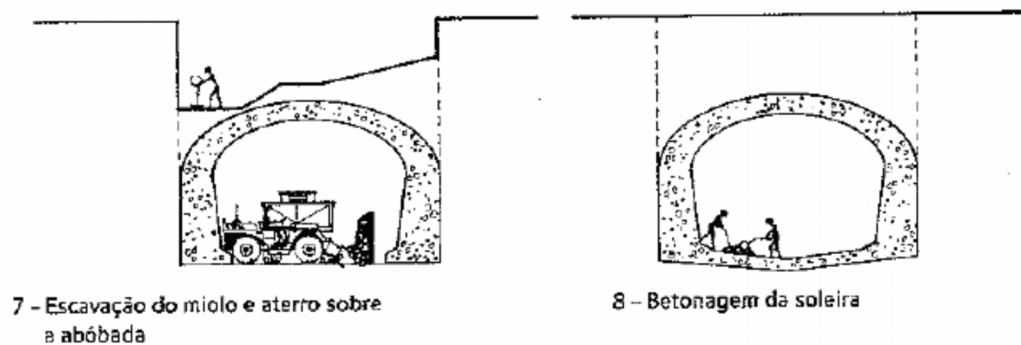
Cut and Cover* - (Vala Estreita), Escavação do interior da galeria, aterro sobre a abóboda e betonagem da soleira.
